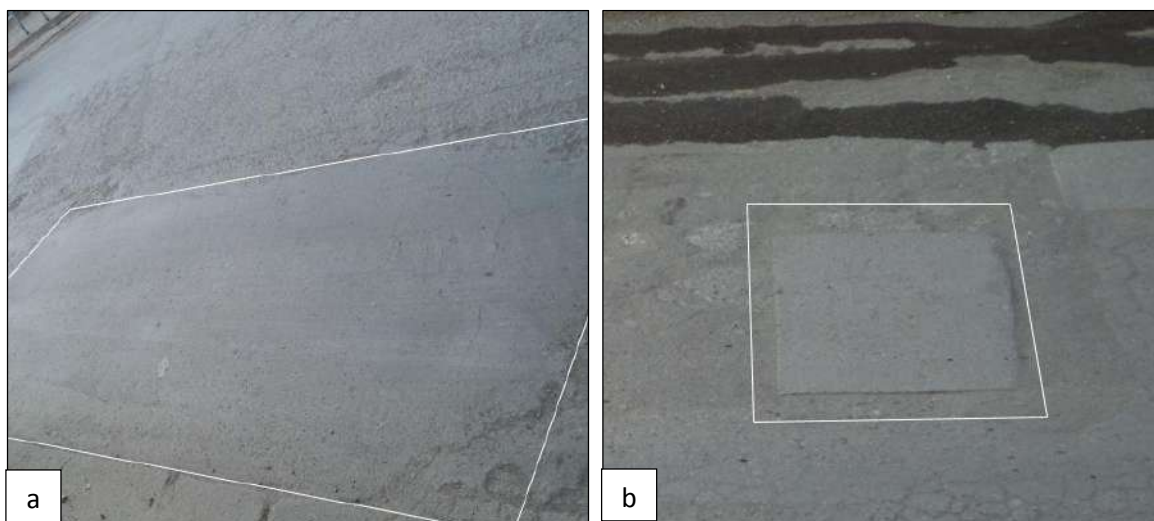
Parches de concreto asfáltico (a) y rígido (b) de severidad bajo
